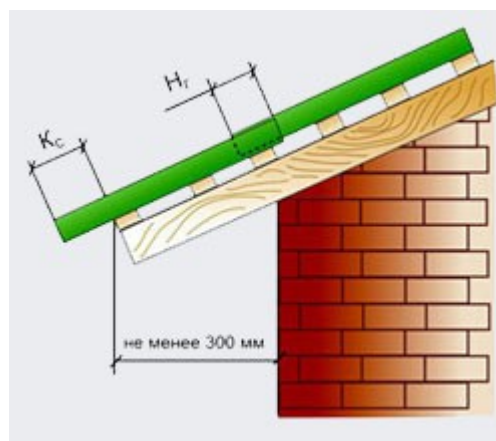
Карниз кровли из профнастила: H_g — нахлест горизонтальный; K_c — карнизный свес.
